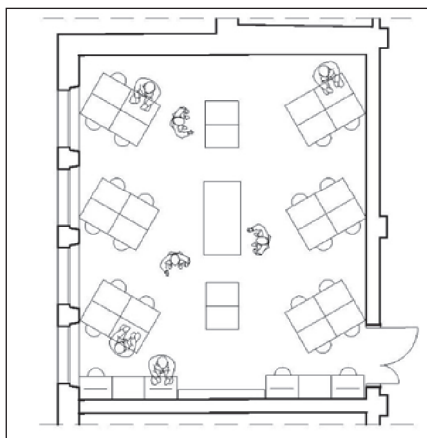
Disposizione degli arredi a “isole” – banchi a spina di pesce
